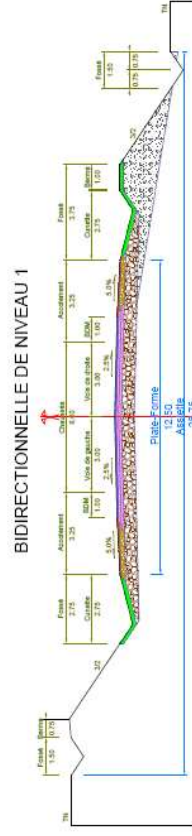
Profil en travers type de la voirie actuelle - voirie bidirectionnelle de niveau 1
